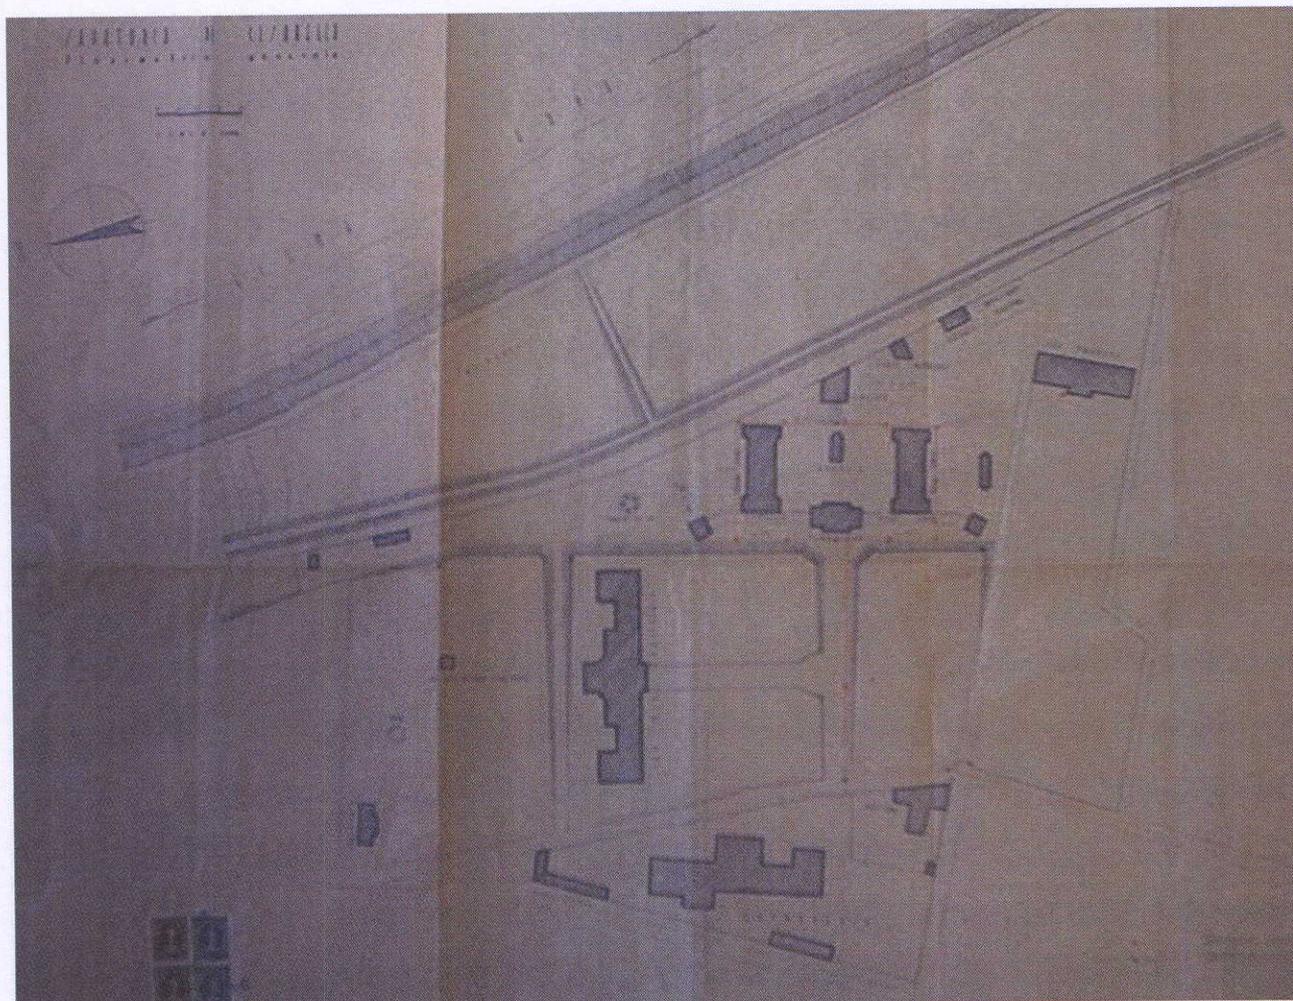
Planimetria di progetto per il nuovo impianto idrico (1948).
